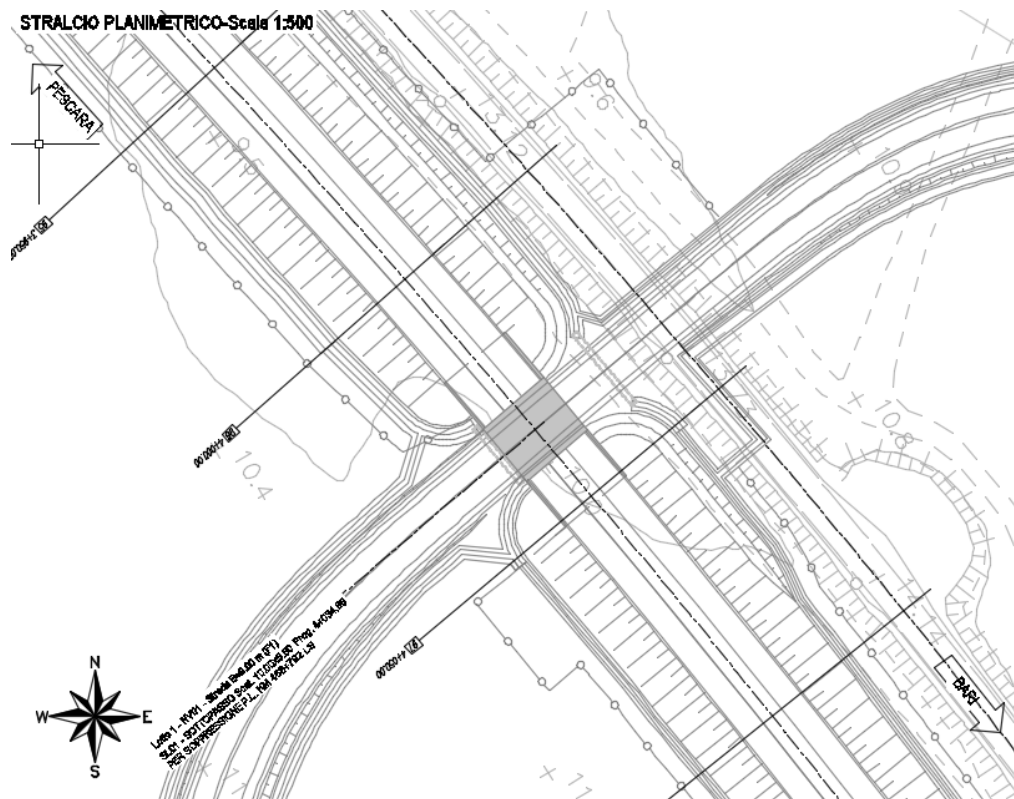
Sottopasso stradale in c.a. – Vista in pianta
